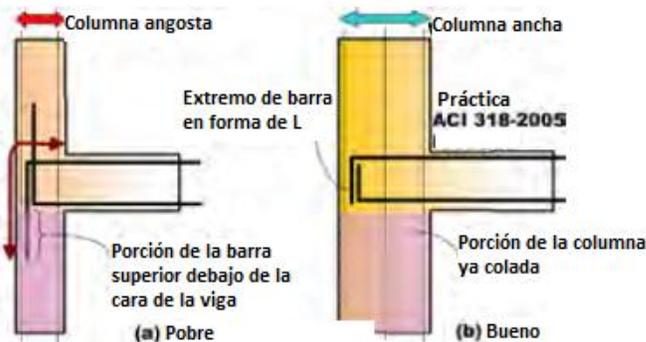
Detallado del anclaje de las barras de vigas en uniones exteriores (fuente: Murty 2005).
